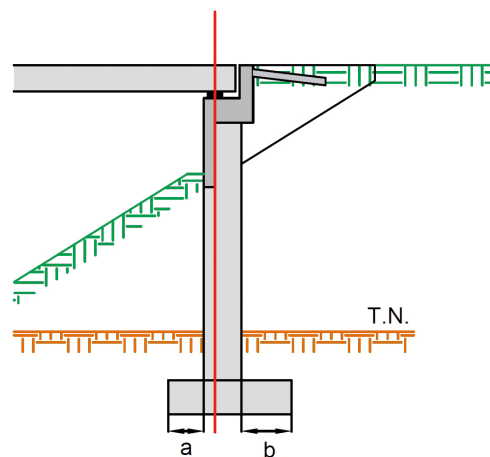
Position non centrée de la semelle d'une culée à mur de front
